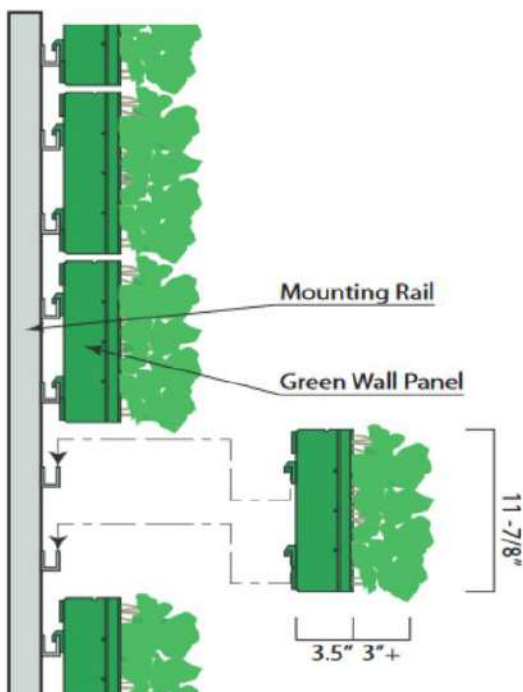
Muro verdes sistema Hidropónico, Gsky, Fuente Google imágenes
